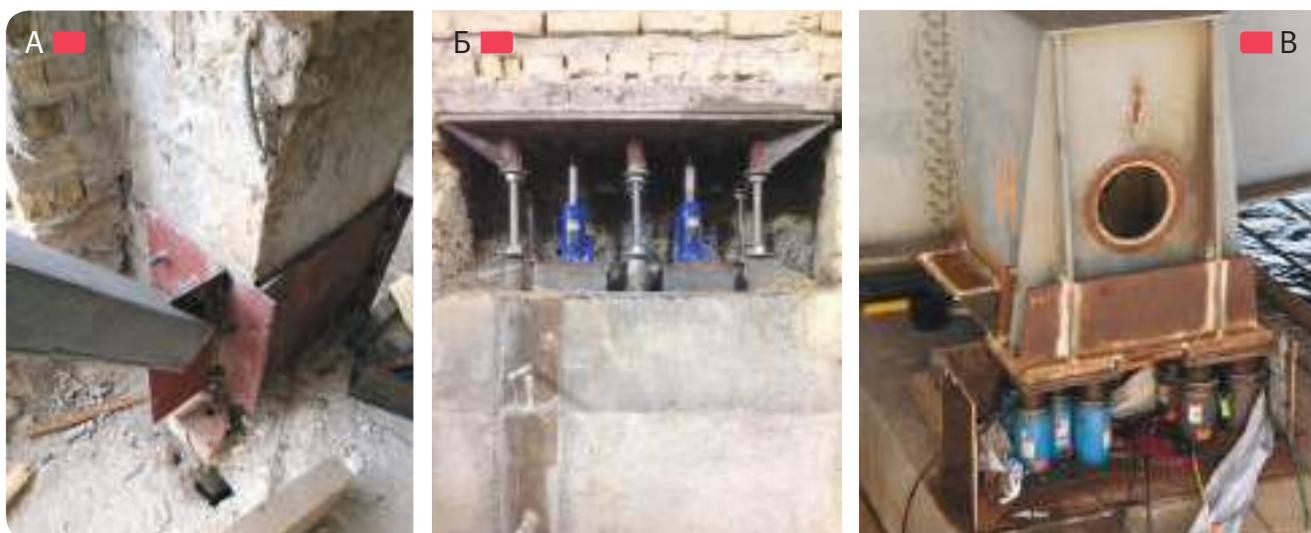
А – включение в работу узла крепления стальных связей к железобетонной колонне стягиванием в процессе выполнения; Б – включение в работу стальной перемычки с применением домкратов; В – подъем мостовой опоры на домкратах с целью подведения новых фундаментов
